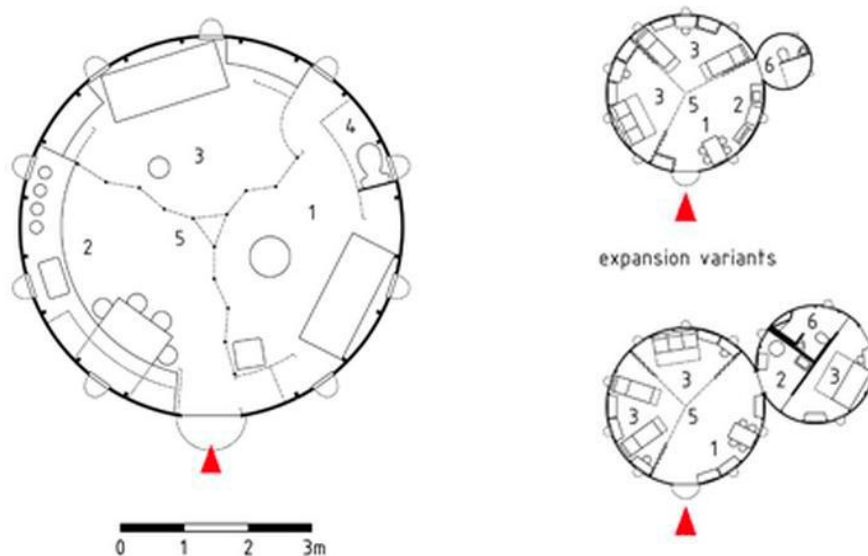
Planta Tipo e as suas variações de expansão da planta tipo - “Dymaxion Deployment Unit”
